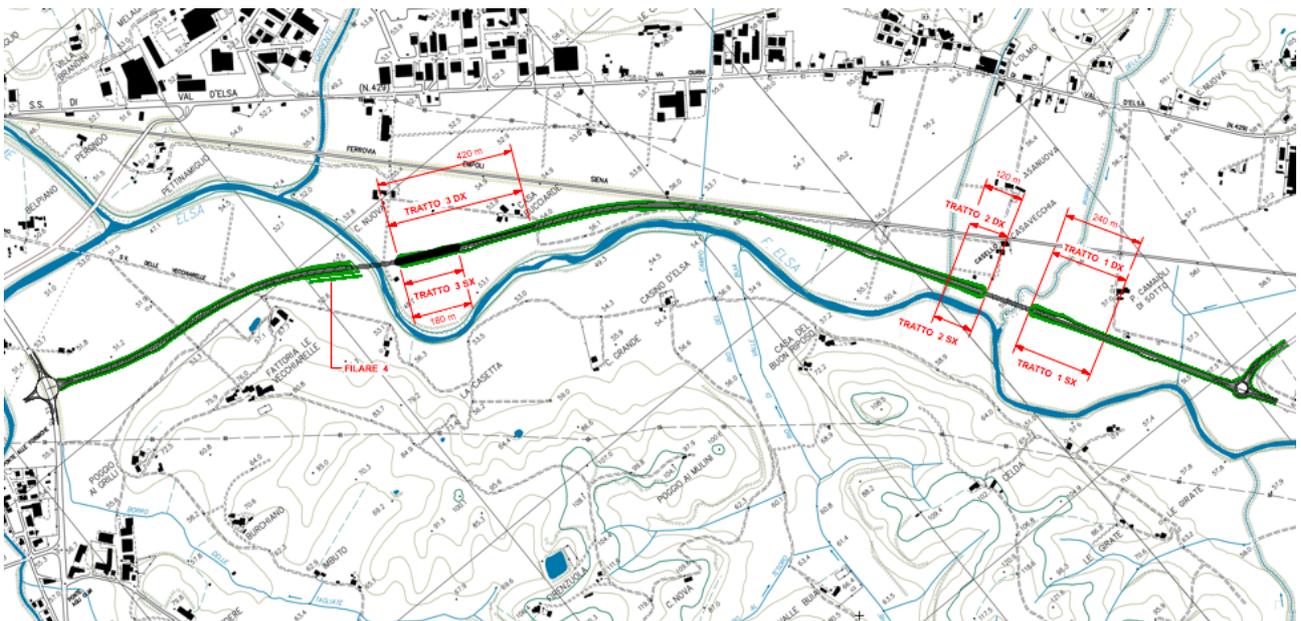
Planimetria di posizionamento delle opere di mitigazione a verde sui rilevati stradali.
